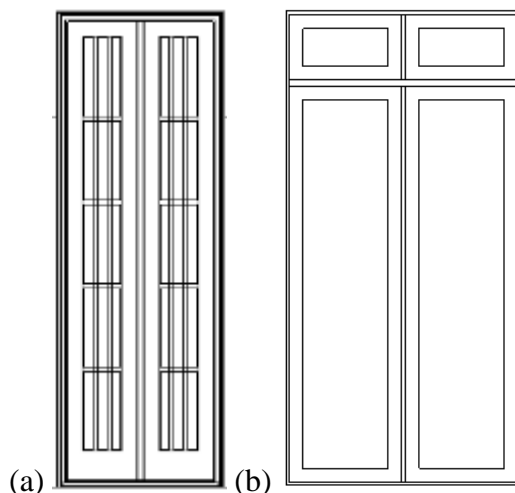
Ilustração da vista frontal: a) portas; b) janelas
